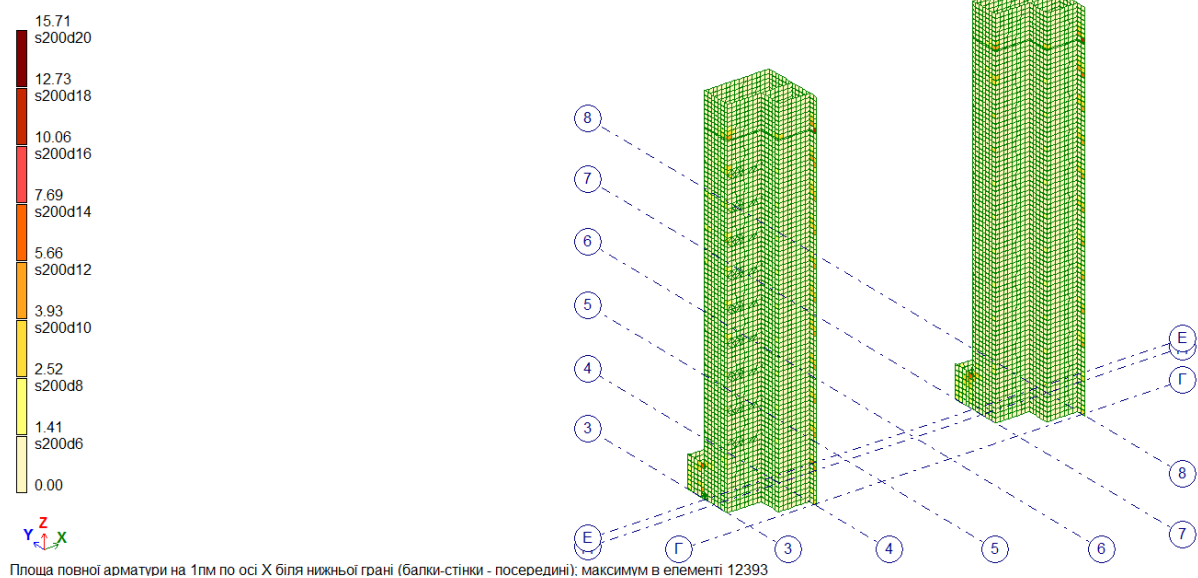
Ізополя розрахункового армування стін сходово-ліфтового блоку. Нижня арматура вздовж осі X
